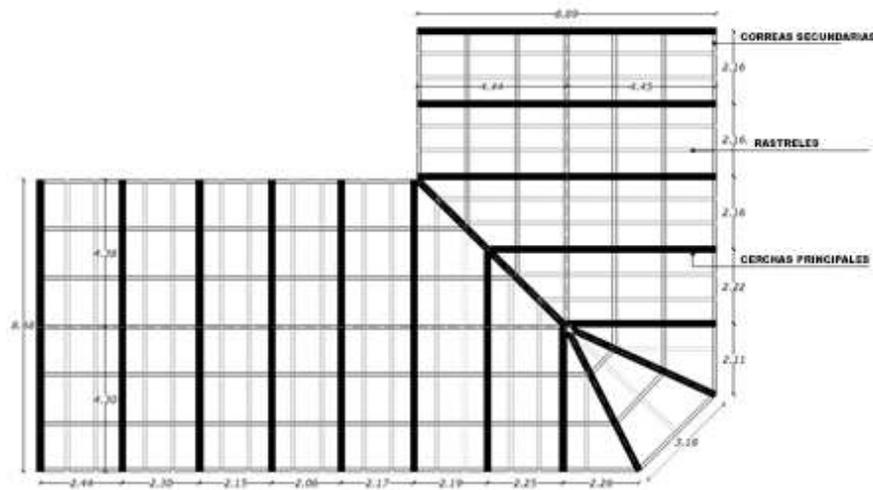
Esquema Estructura de Cubierta de madera. Fuente: Elaboración propia
